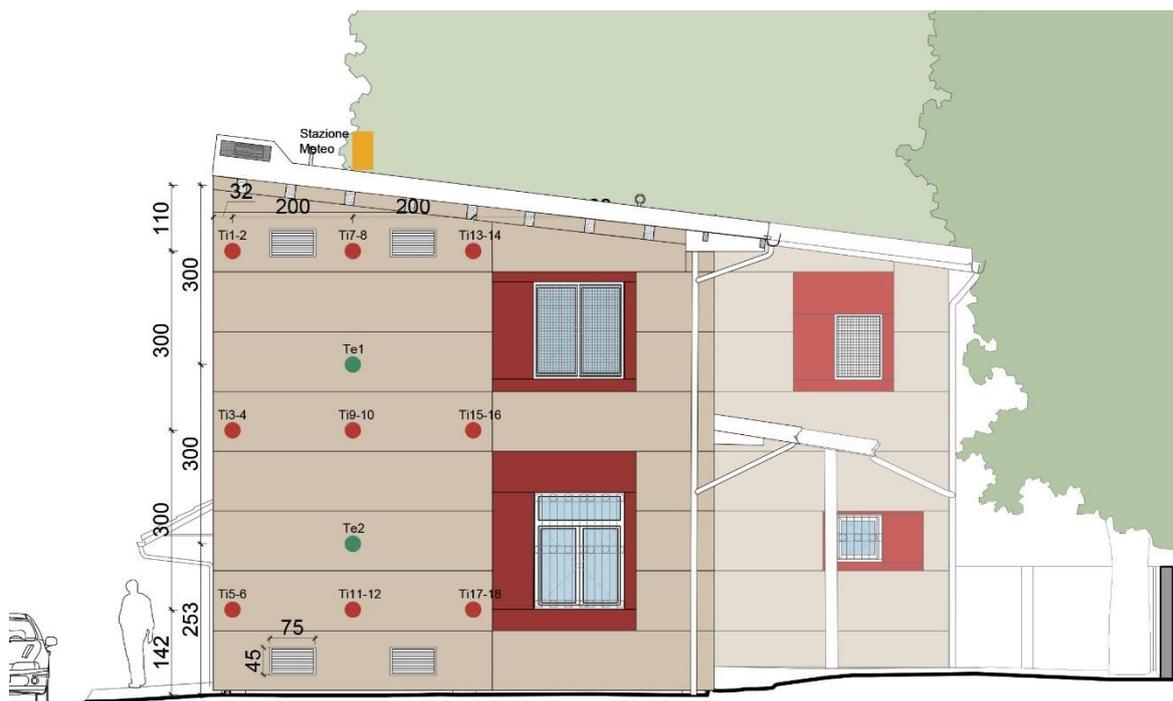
Progetto preliminare delle griglie di ventilazione sulla facciata
